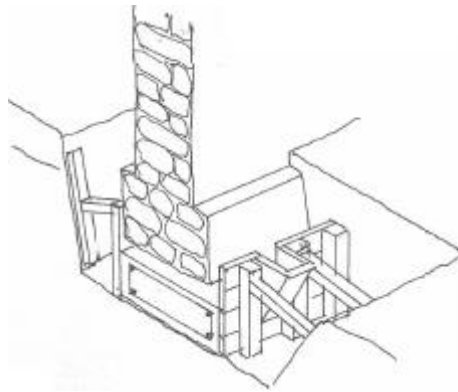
Visão da cofragem efetuada e do recalce betonado [55]
